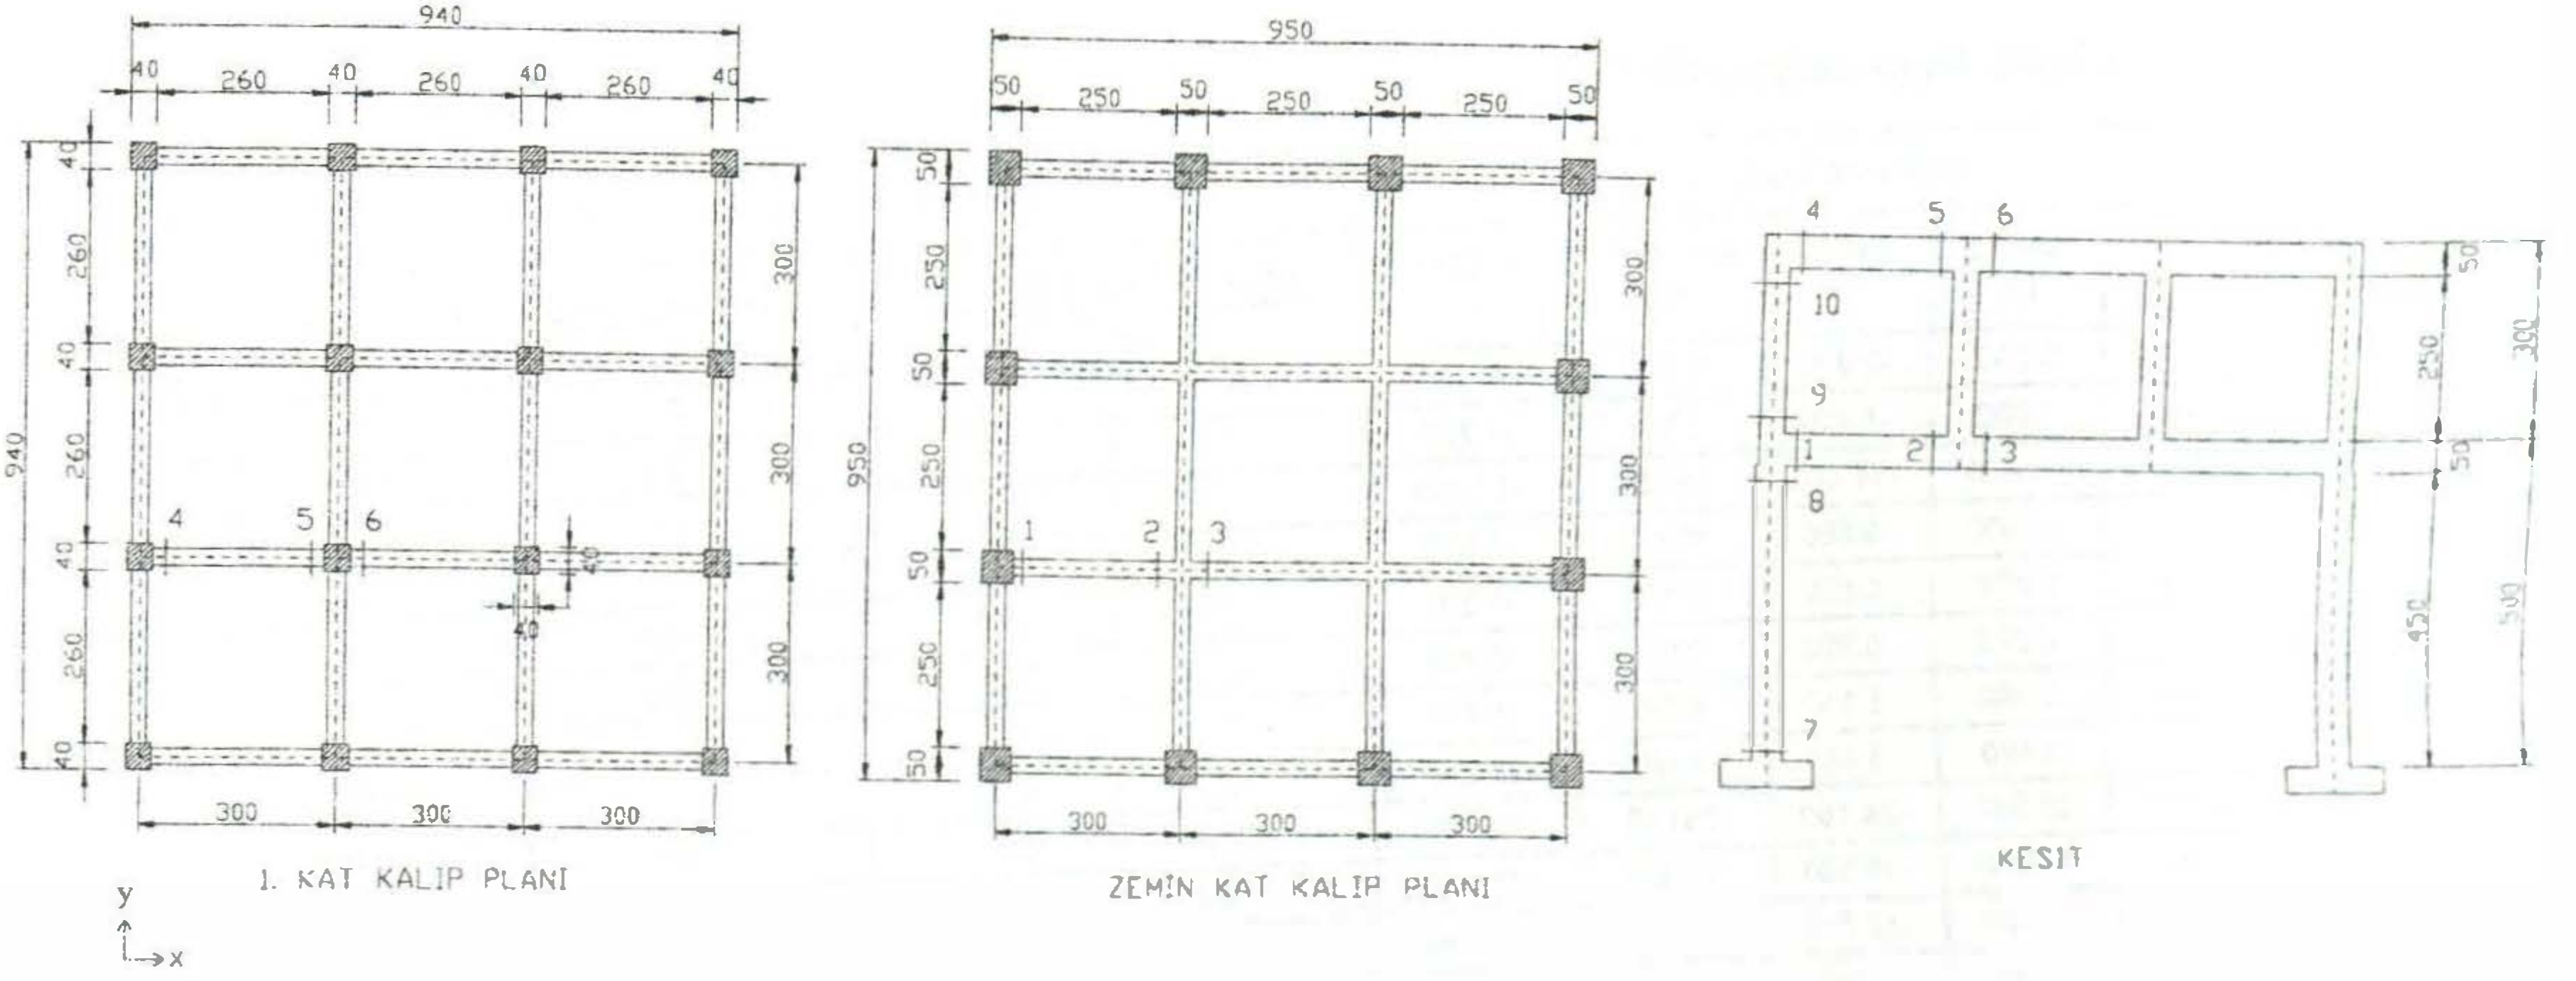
Örnek Yapı - 2 Plan ve Kesit
